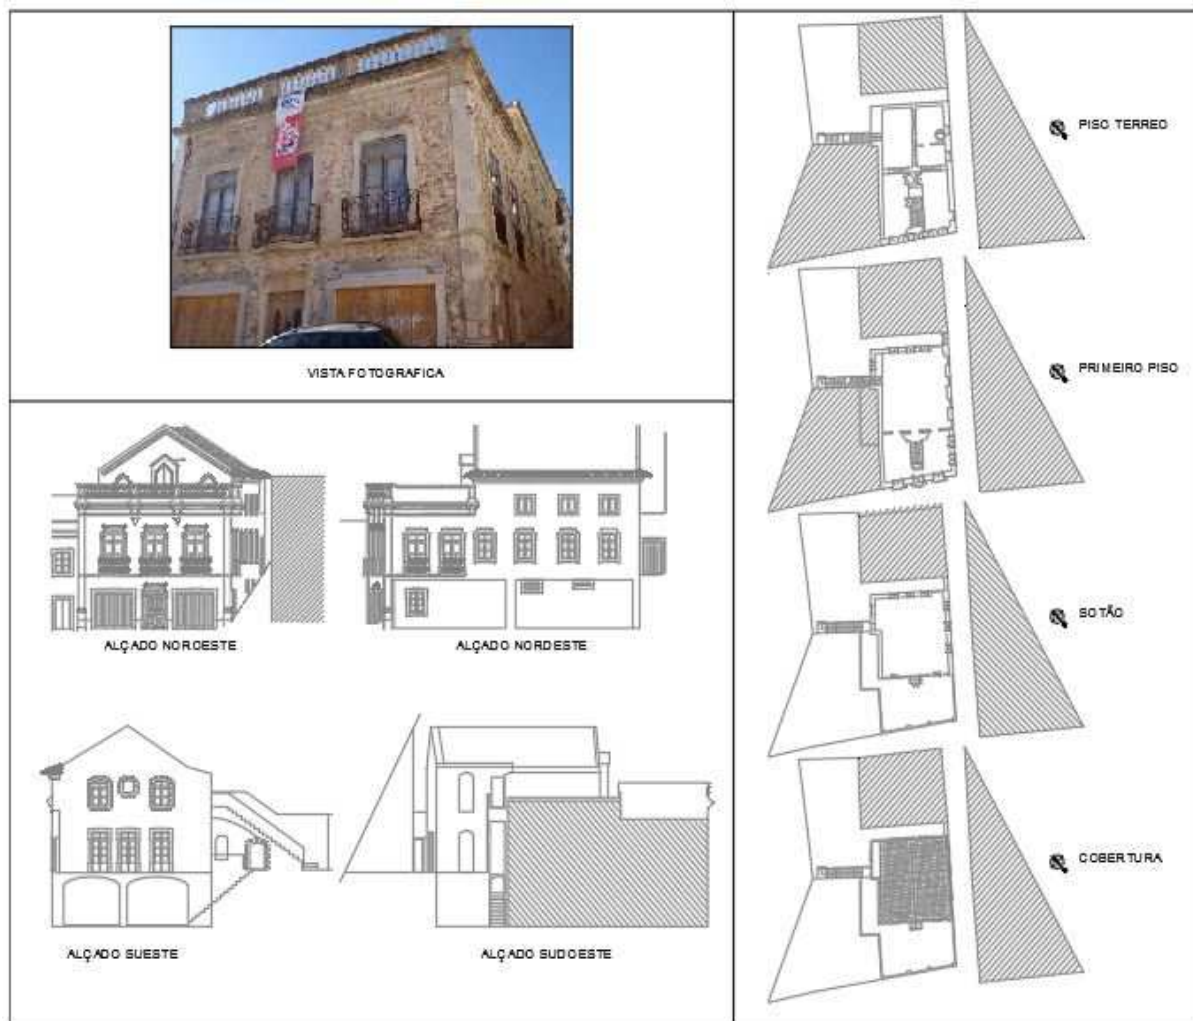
Vista Fotográfica, Plantas e Alçados do Edifício (Arquivo Municipal de Tavira).
